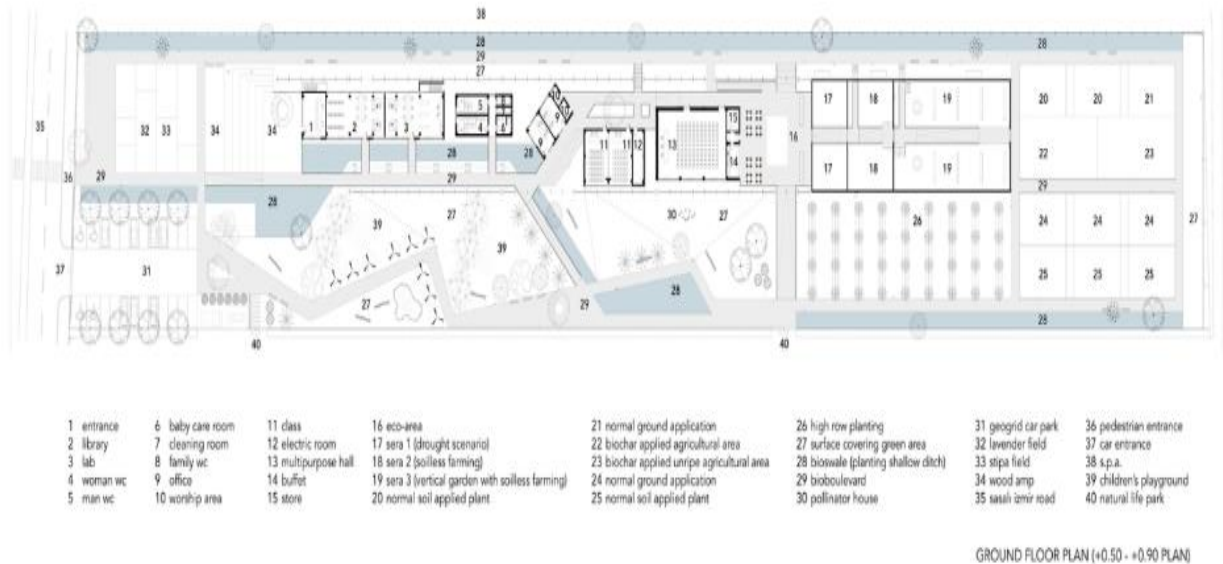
Centro de desarrollo agrícola - Planta cubierta arquitectónica
